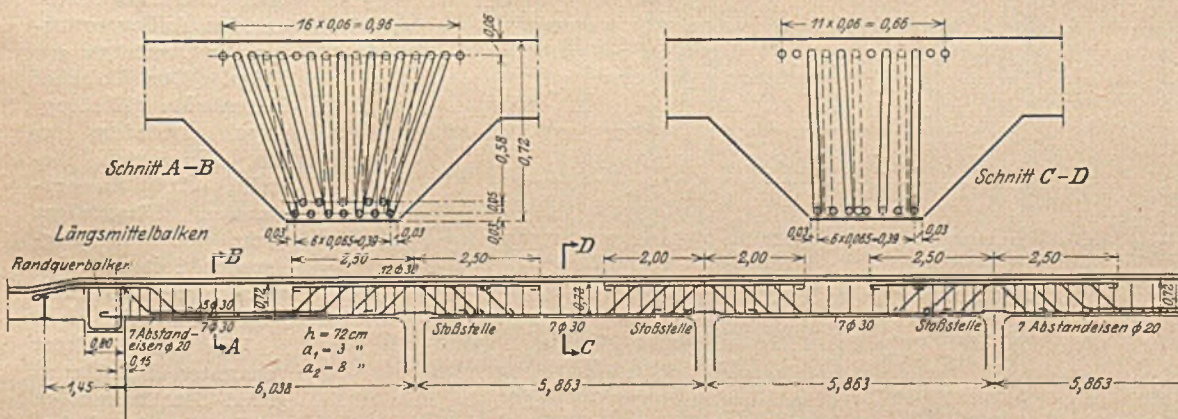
Deckenunterzug Bahnhof Hasenheide.
